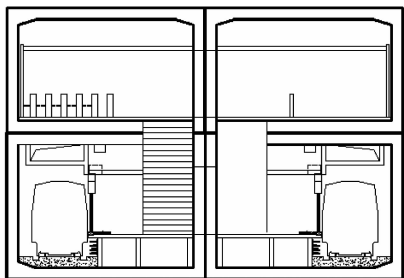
采用矩形顶管分步顶进施工的地铁车站横断面示意图
